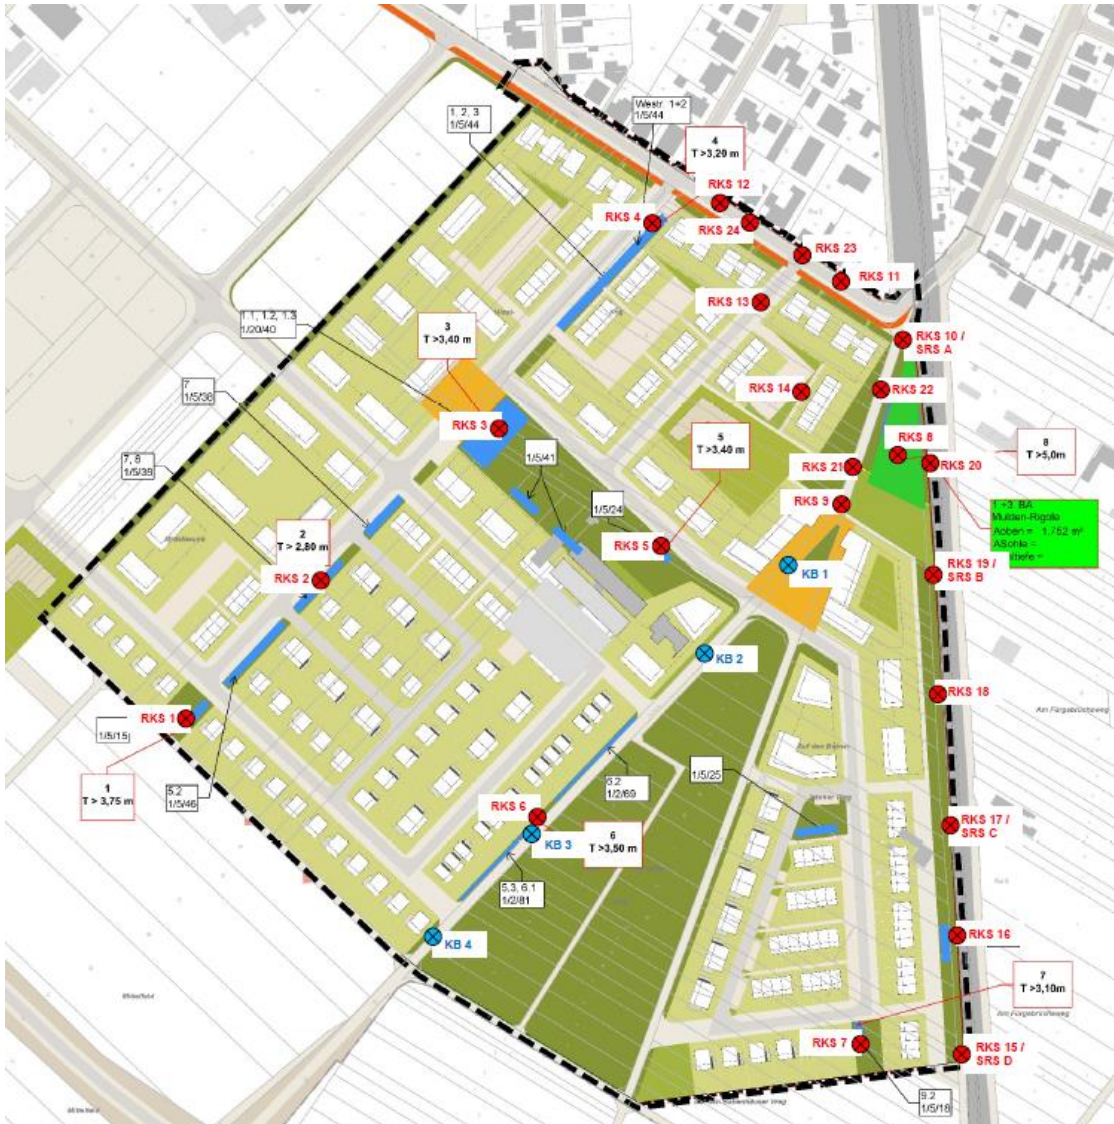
Auszug aus dem Geotechnischen Ergebnisbericht der GEO-Consult GmbH (2020) (Anlage 1: Lageplan der Aufschlusspositionen mit Darstellung des ursprünglichen Geltungsbereichs), unmaßstäblich
